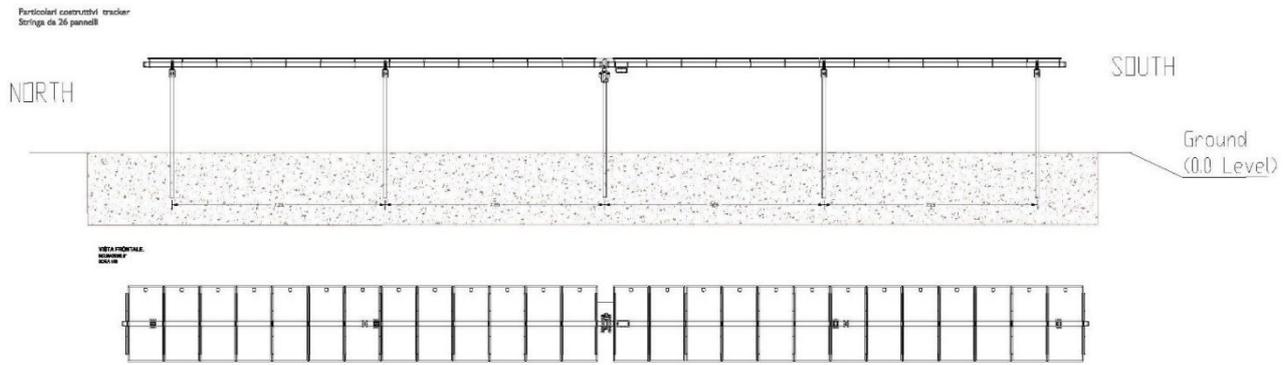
Vista laterale e vista dall'alto della singola stringa da 26 moduli
